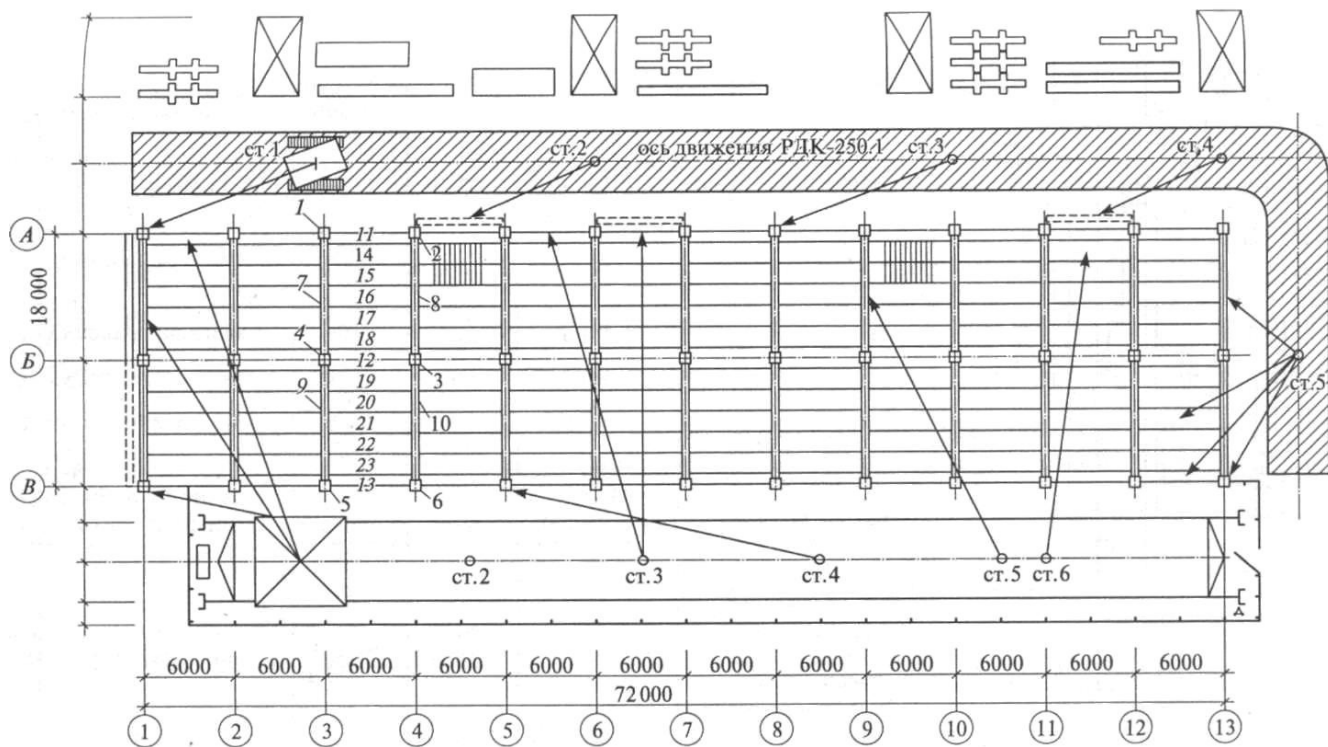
Фрагмент стройгенплана на период монтажа надземных конструкций многоэтажного каркасного здания
